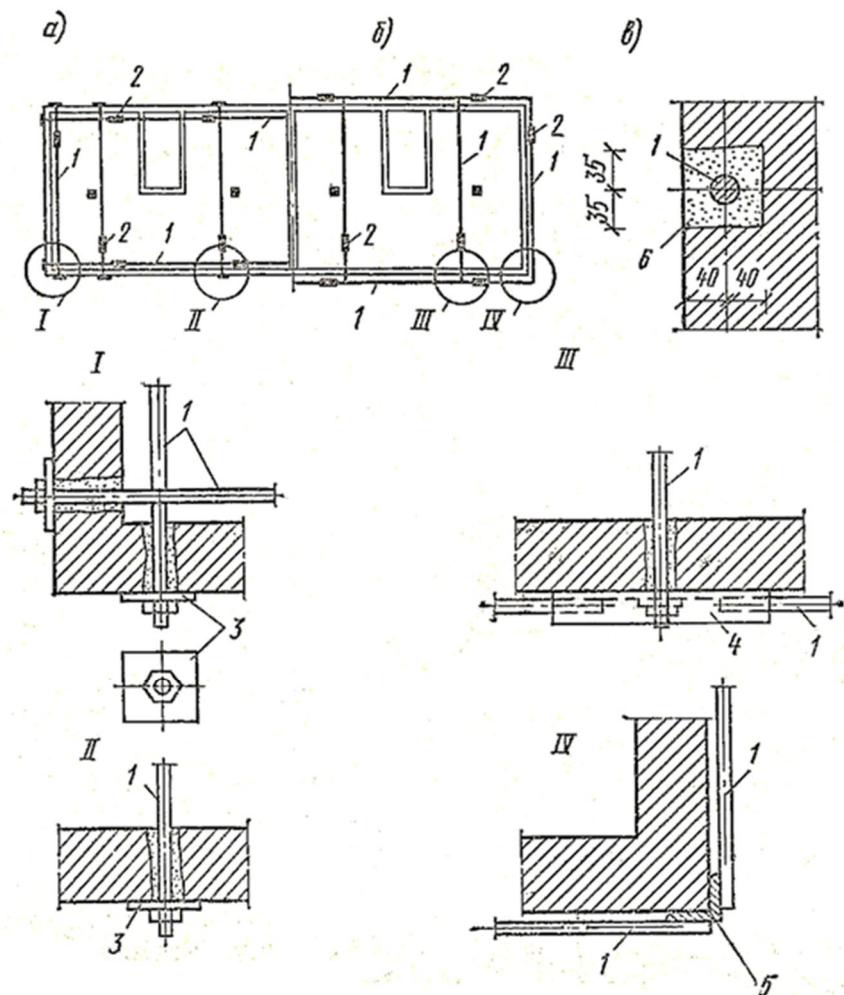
Крепление стен металлическими тяжами в уровне перекрытий:
